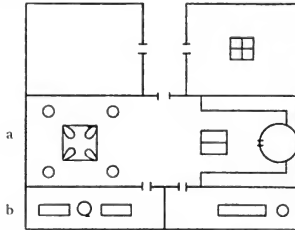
Brauhaus auf dem Grundrisse zu St. Gallen. (Gebäude links.)
